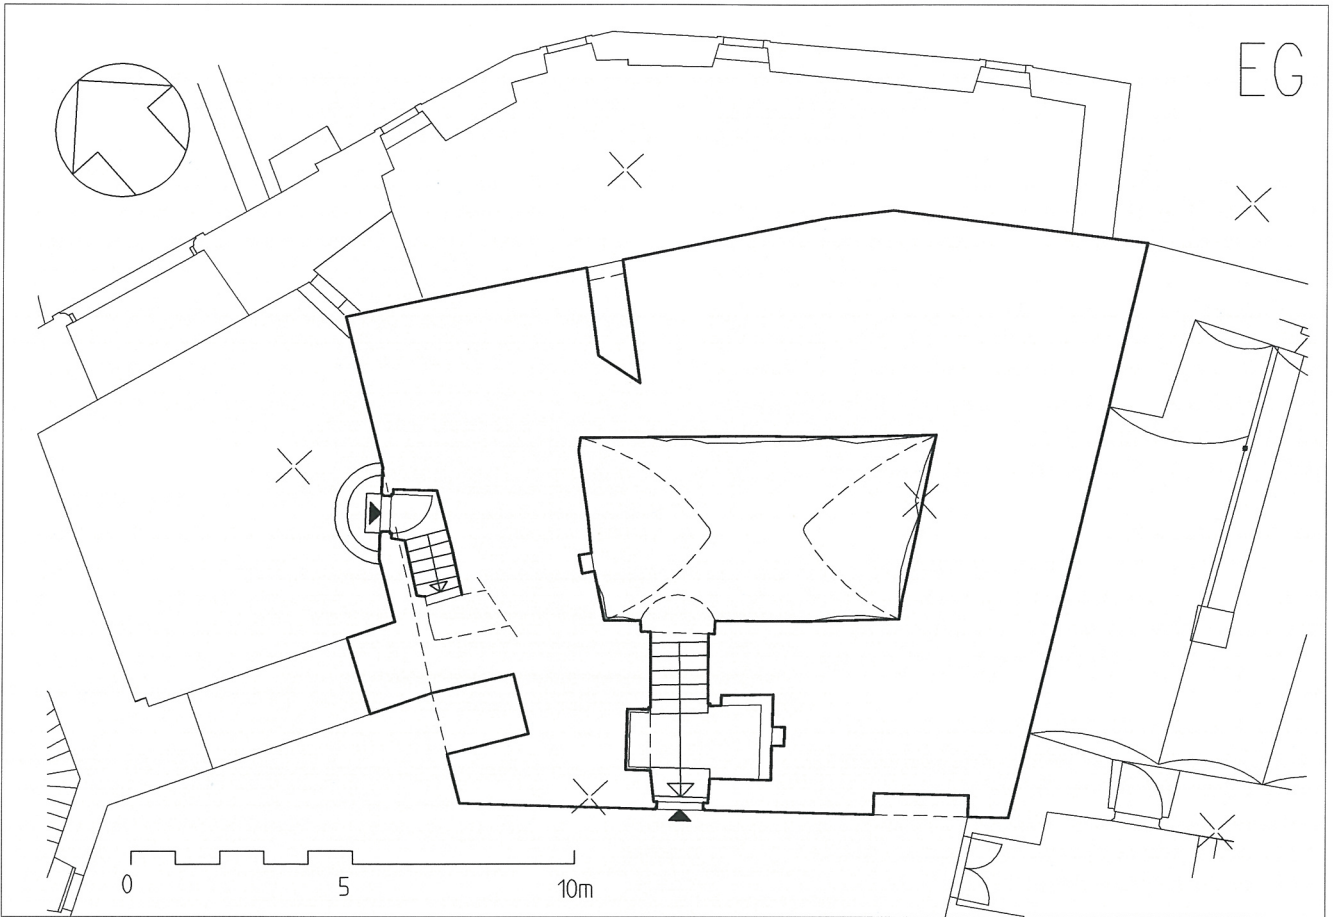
Grundriss Erdgeschoss = Ebene Schlosshof
